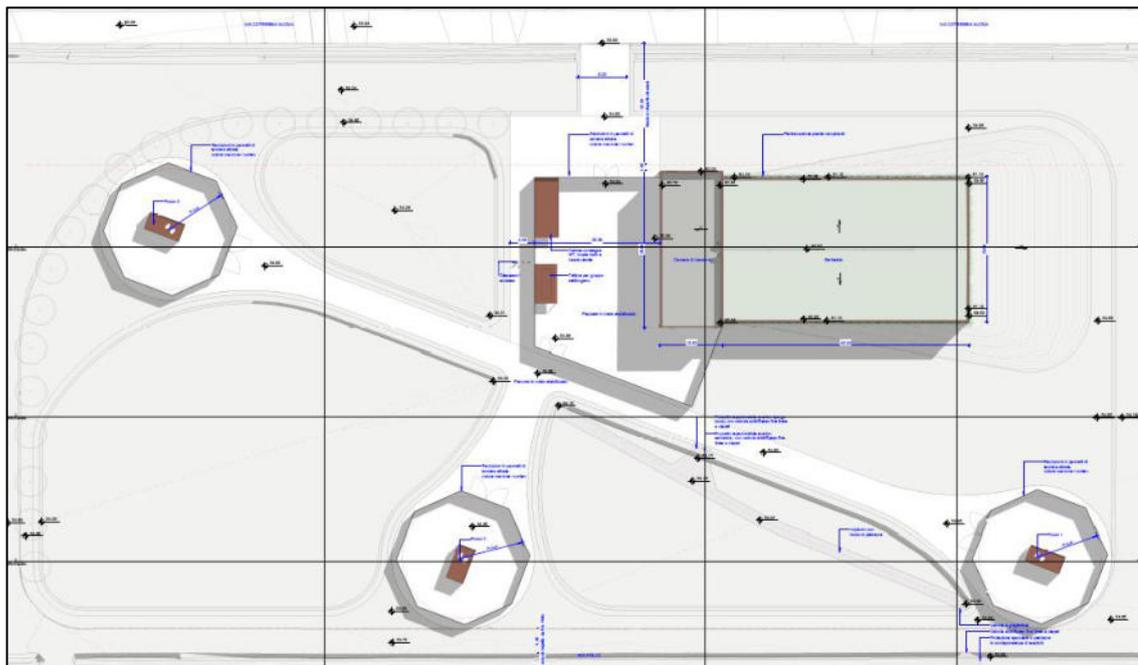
Stralcio del progetto dell'area per la realizzazione dei nuovi pozzi e della centrale idrica
